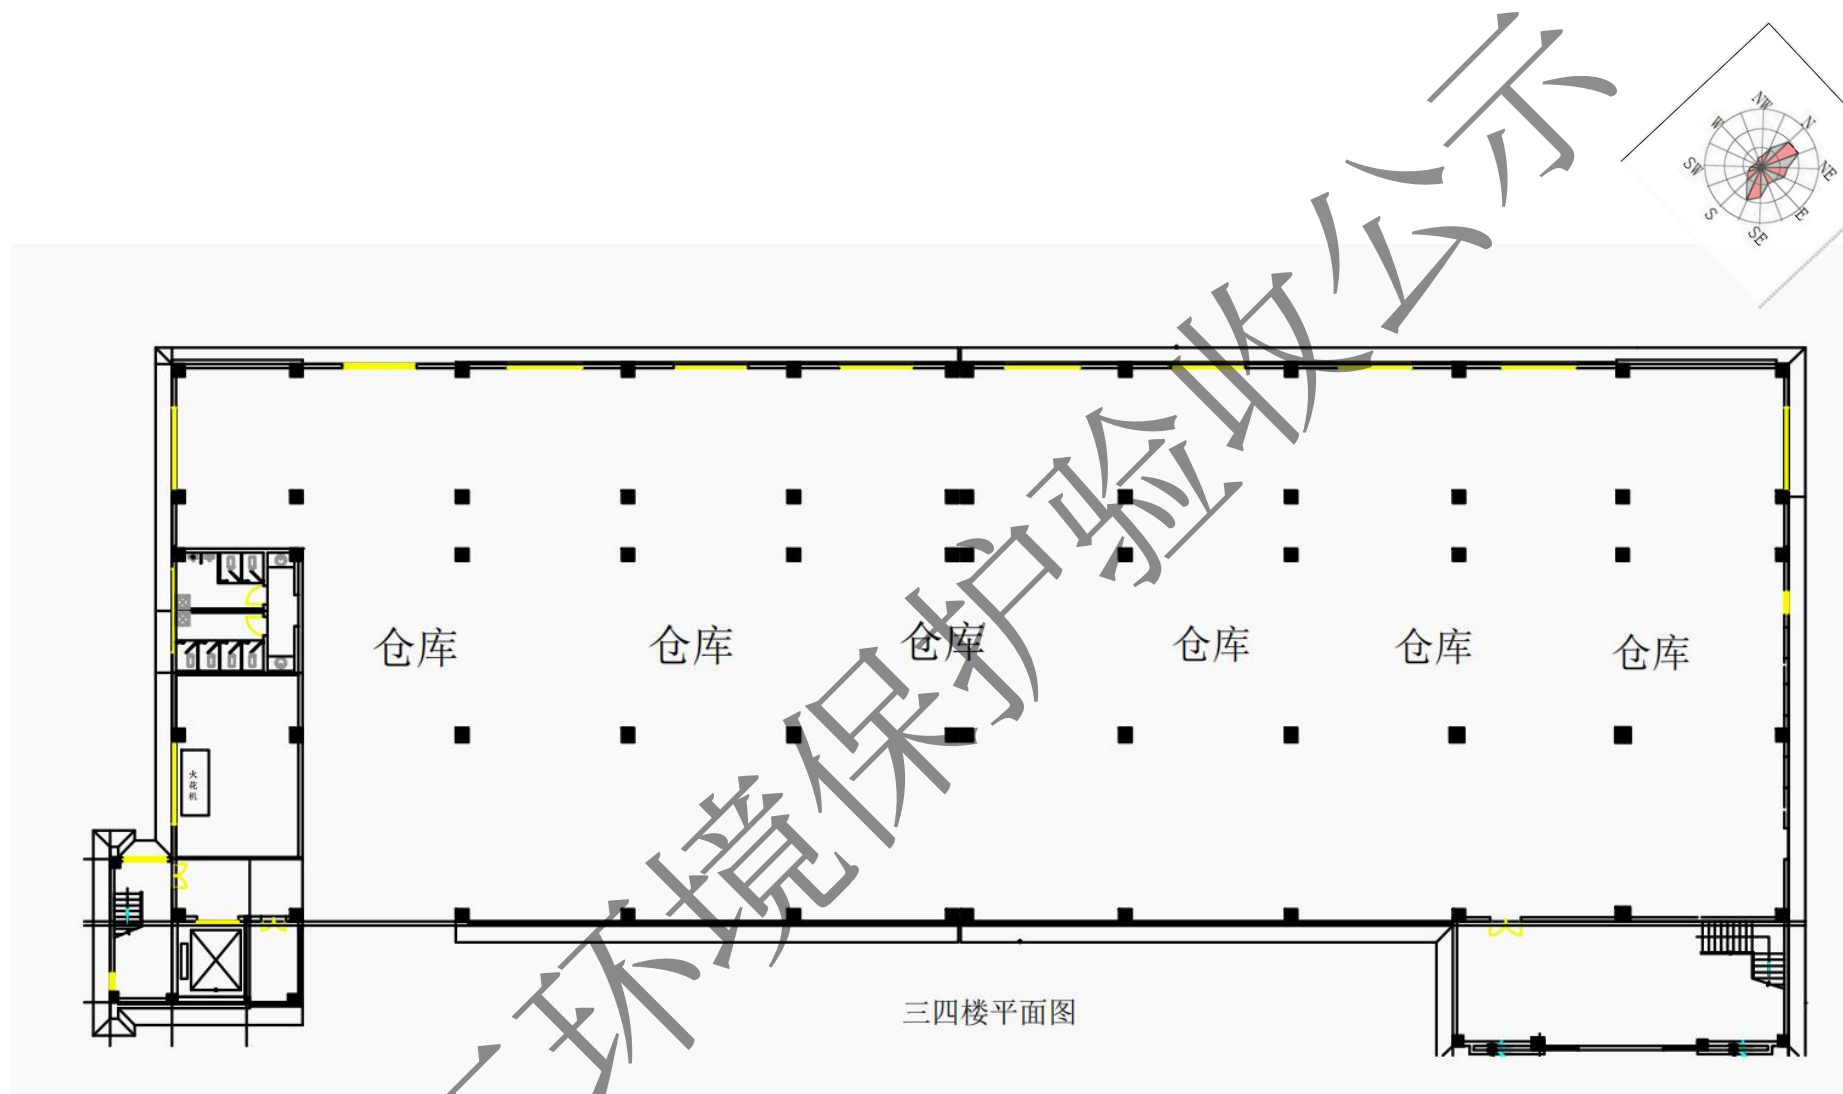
(3) 平面布置图 (1#厂房三、四层)
